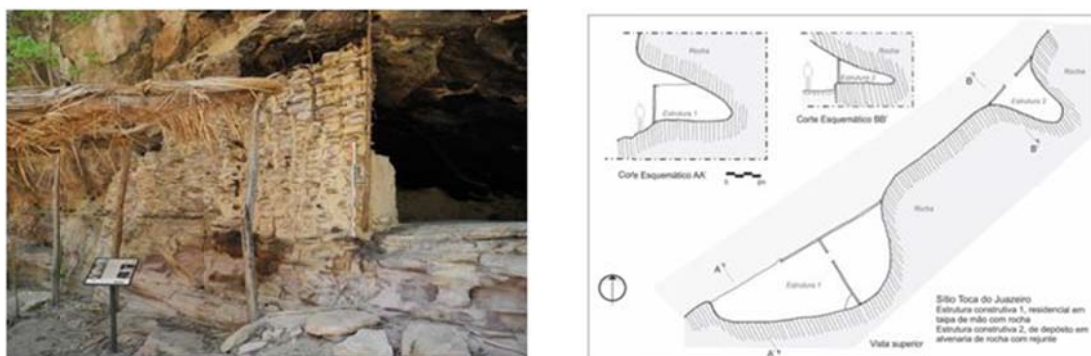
Situação atual da estrutura construtiva A, em taipa de mão com rocha, do Sítio Toca do Juazeiro levantamento esquemático da reocupação do sítio pré-histórico.
